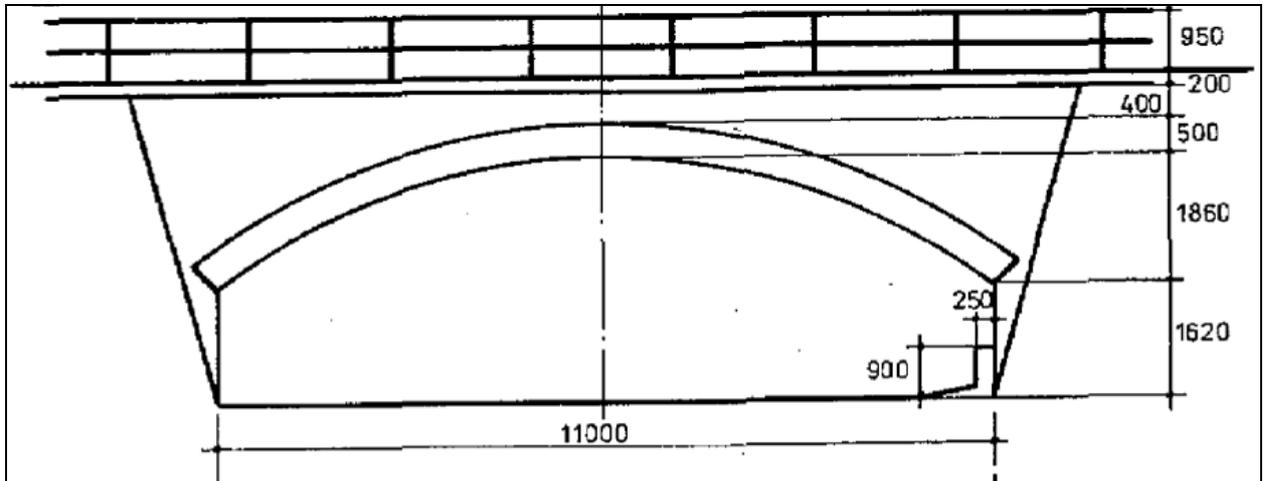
Bestand, Lageplan (Auszug Bauwerksbuch)
